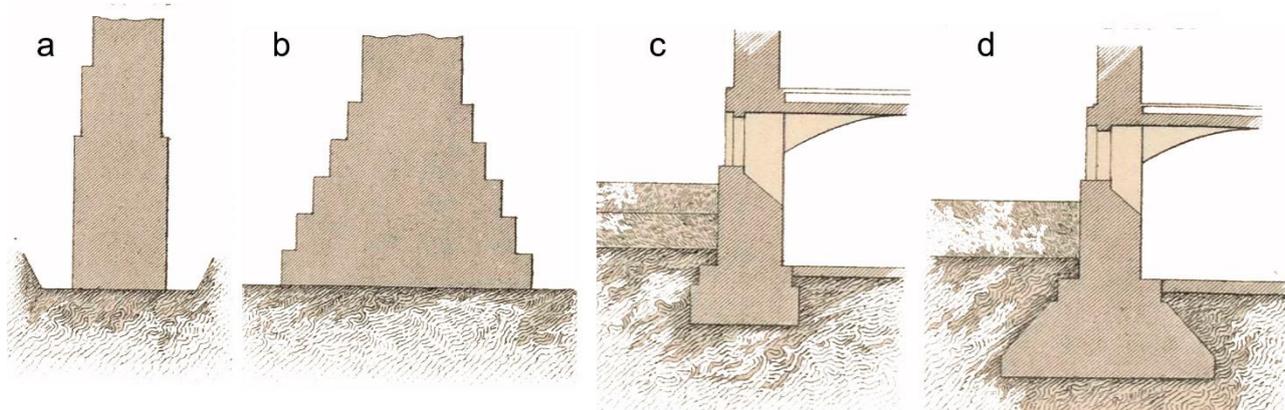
Уширение подошвы строения за счет уступов фундаментной стены (а, b, с) и за счет наклонных боковых стенок фундамента (d) [13]
